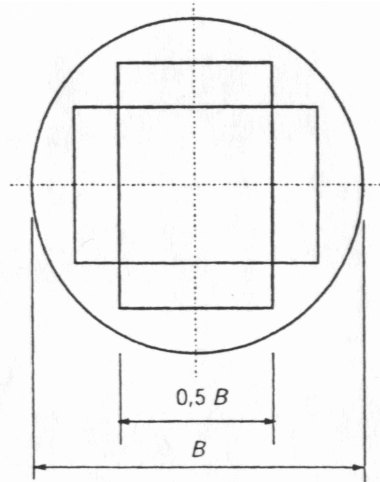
Ортогональна арматура у круглому фундаменті на основі
